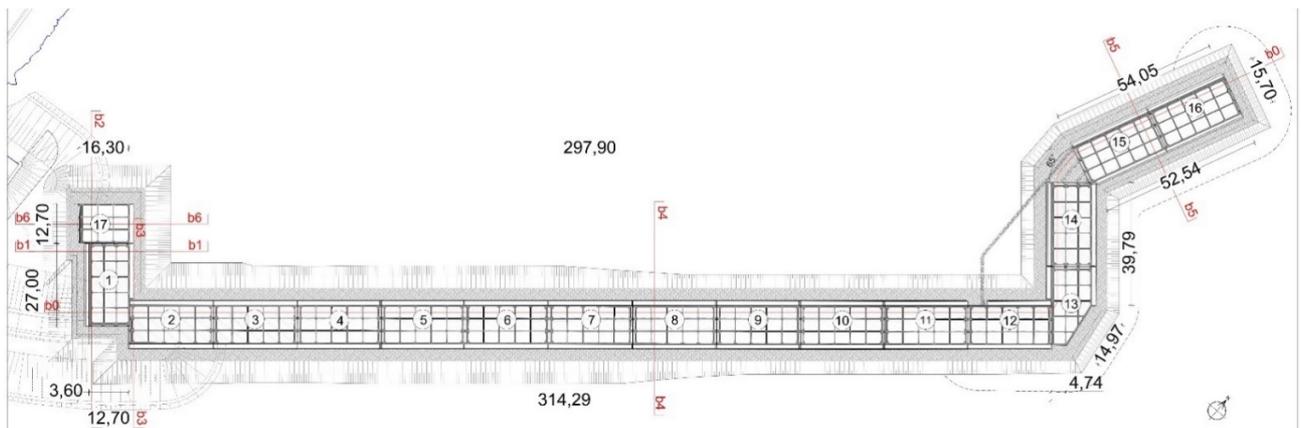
Progetto Esecutivo: Planimetria d'imbasamento dei cassoni
